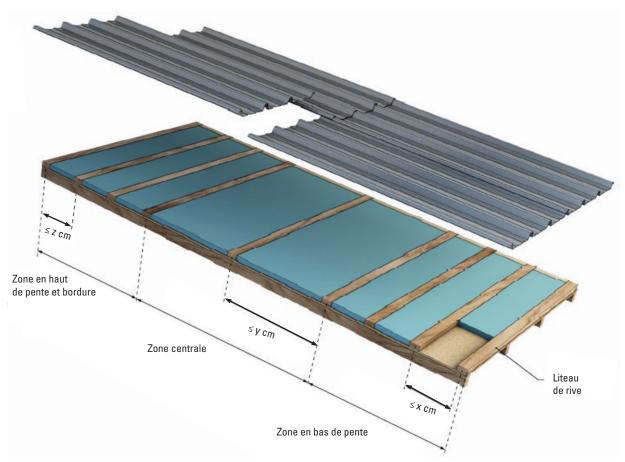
Liteaux fixés à la structure porteuse à travers un parement décoratif bois continu posé sur chevrons
